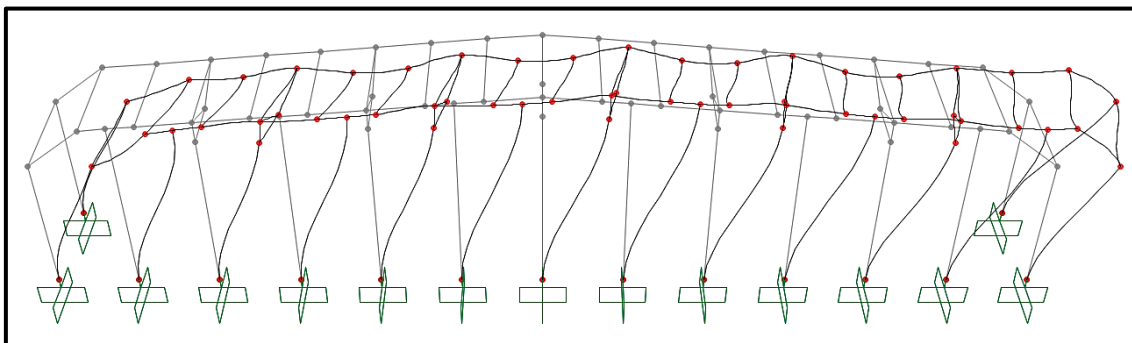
Deformada del muro hastial. Estructura sin arriostrar.
